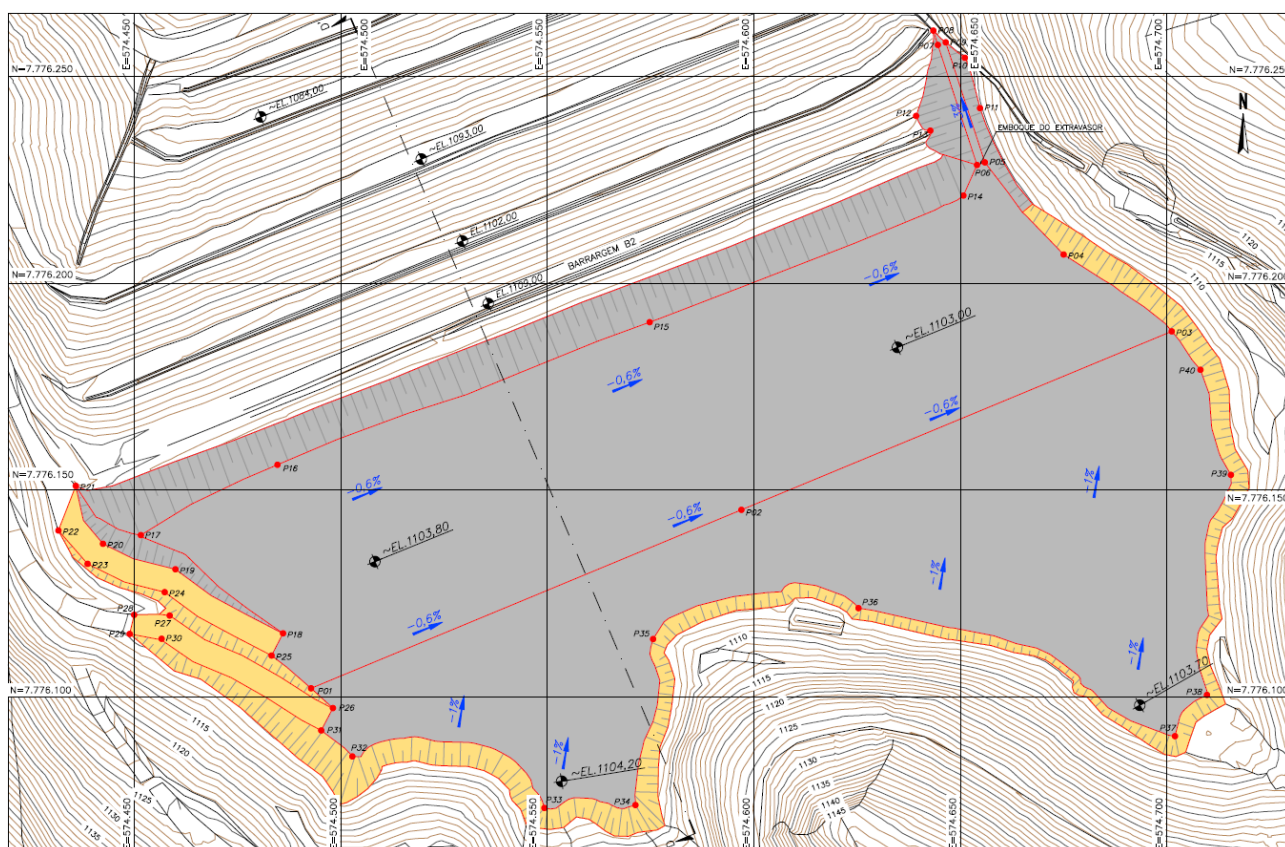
Escavações complementares - Planta (Fonte: IPE.OP.DE.8000.GT.20.1415).
